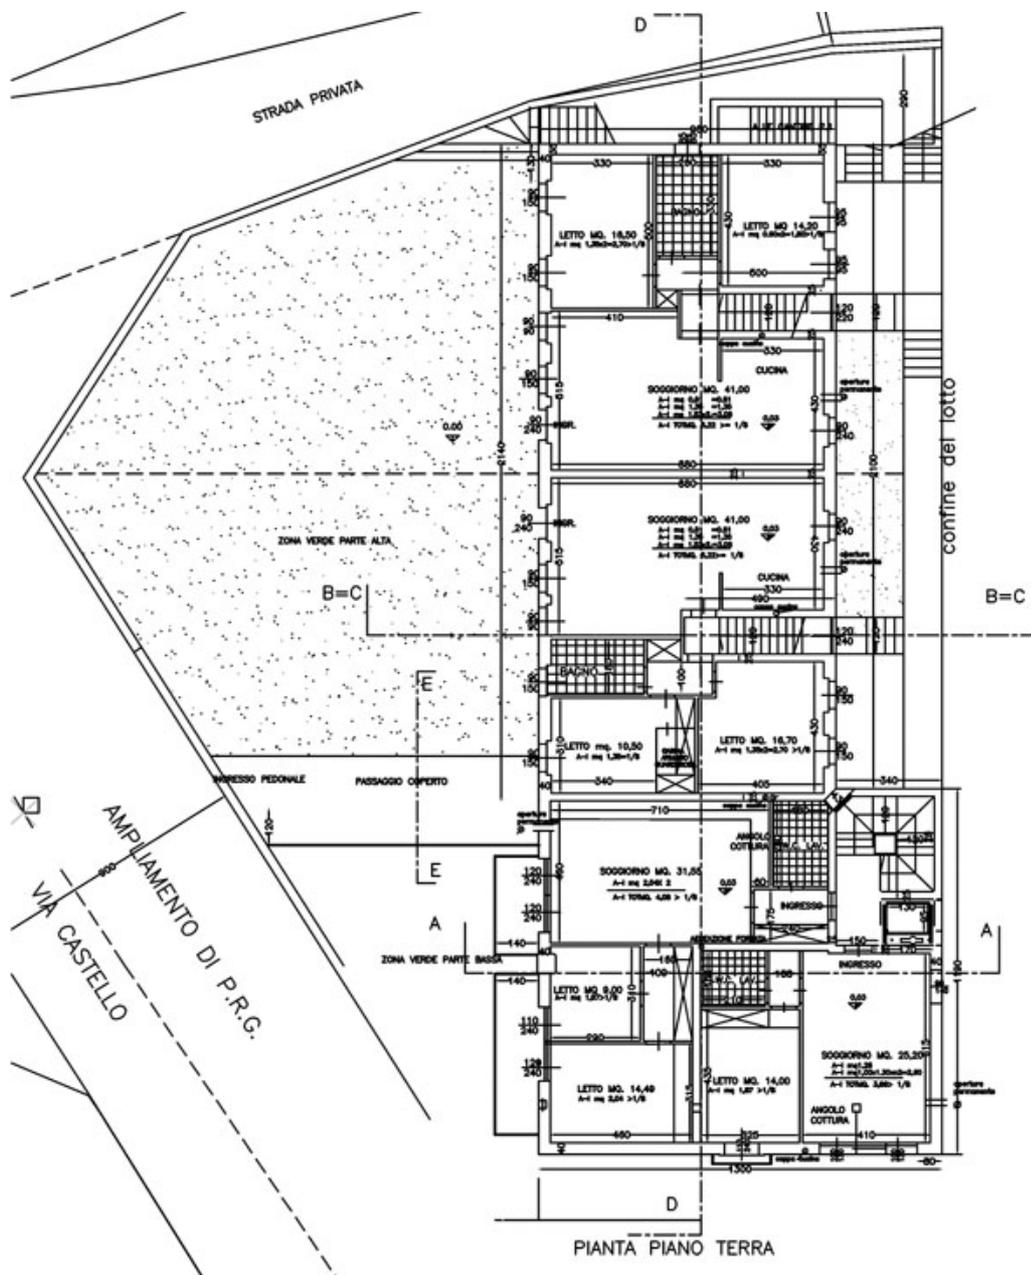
Planimetria del piano terra del progetto del fabbricato oggetto di ricostruzione.
